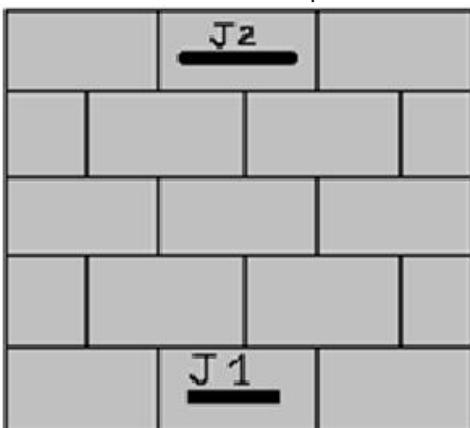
Emplacement des jauges d'essai n°4 Fig. IV.72 Mur 8 trous avec enduit pour l'essai n°4 face jauge.
